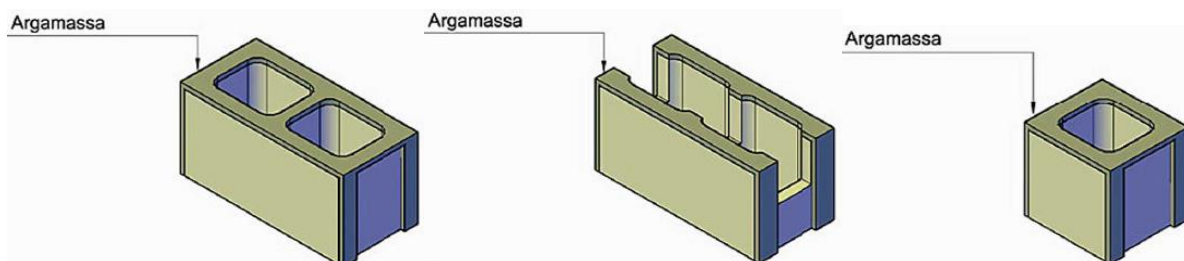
Bloco estrutural - Argamassa nas paredes longitudinais e transversais
